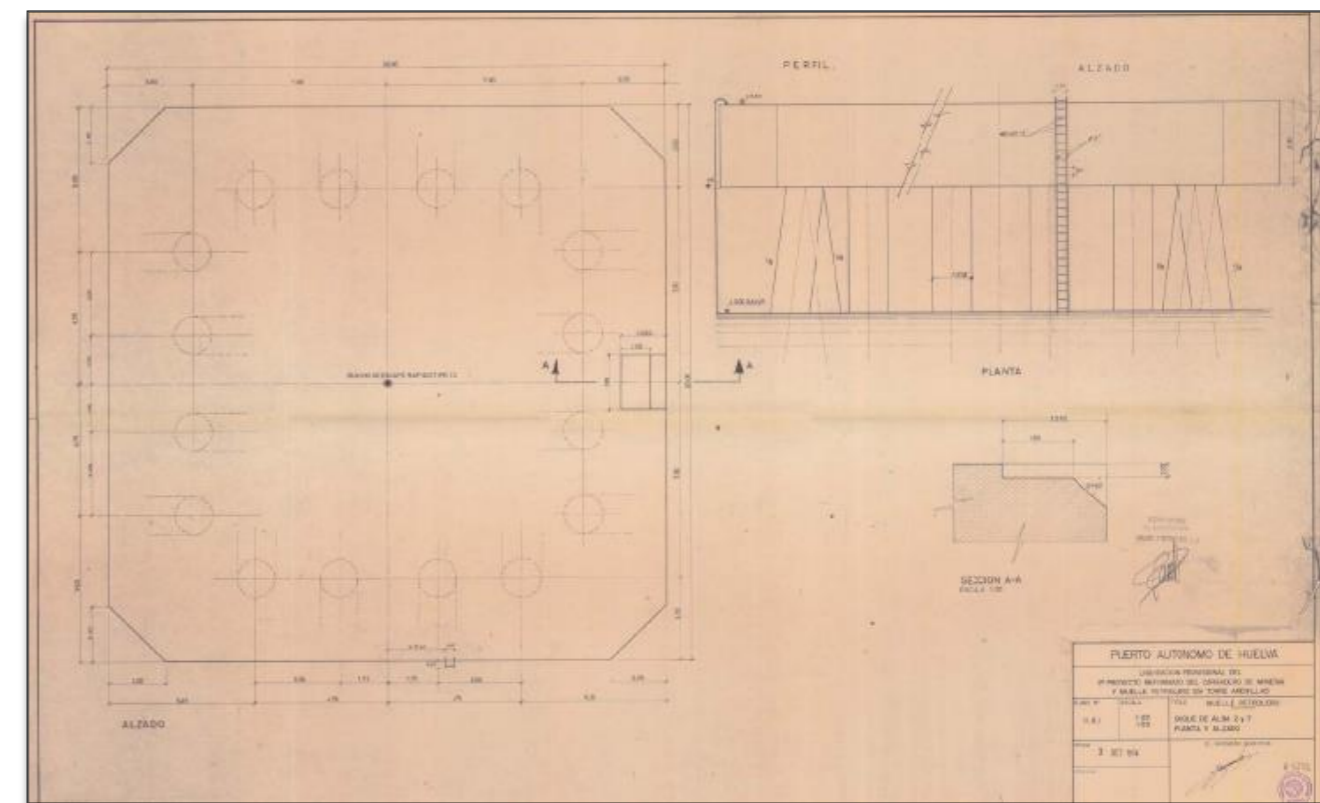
Duque de Alba 2 y 3. Planta y Alzado.
